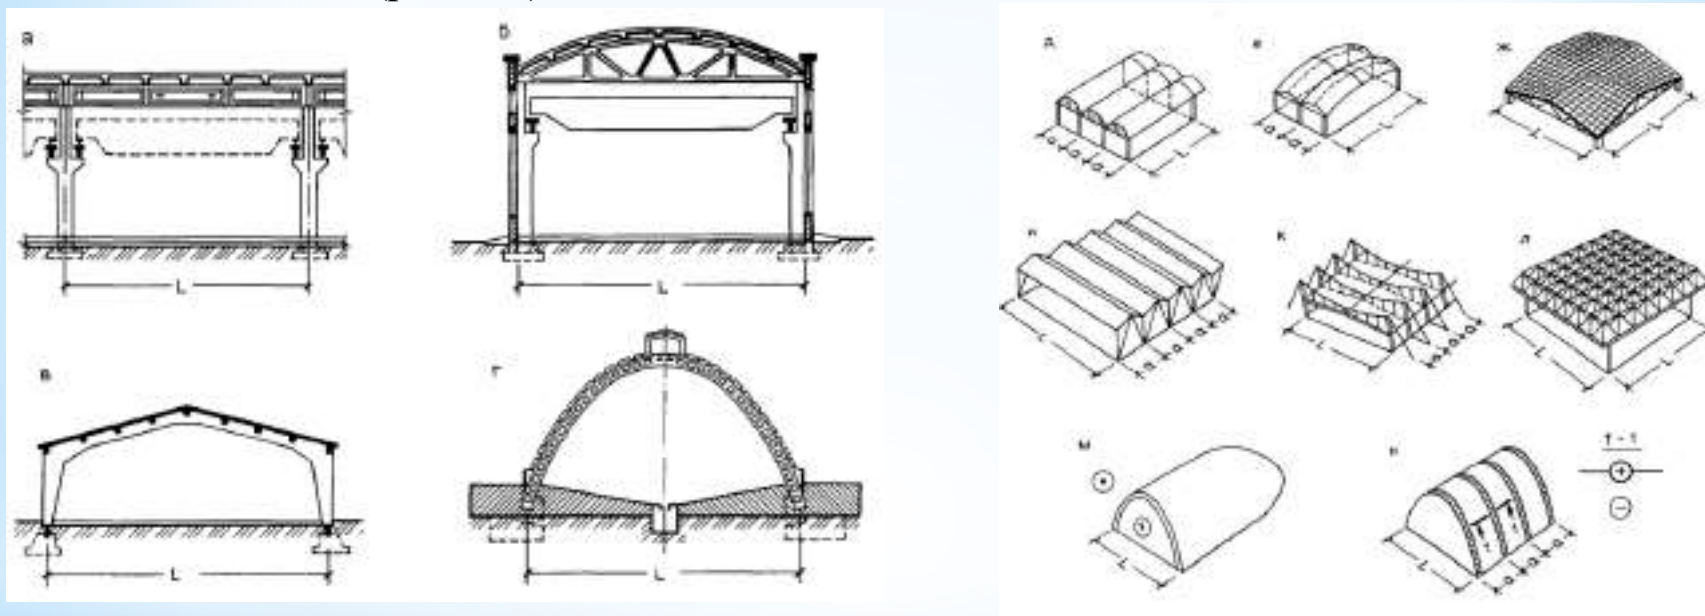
Конструктивные схемы покрытий каркасных промзданий:
